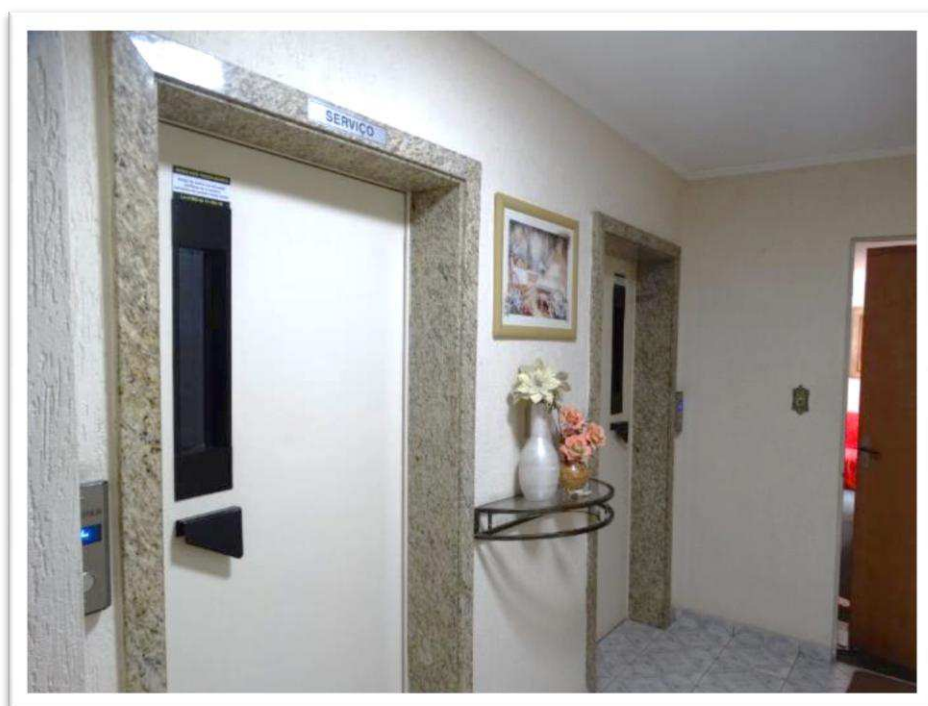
Vista do hall de elevadores do 4º pavimento do bloco 17, onde se localiza o apartamento 44, objeto da presente vistoria.
